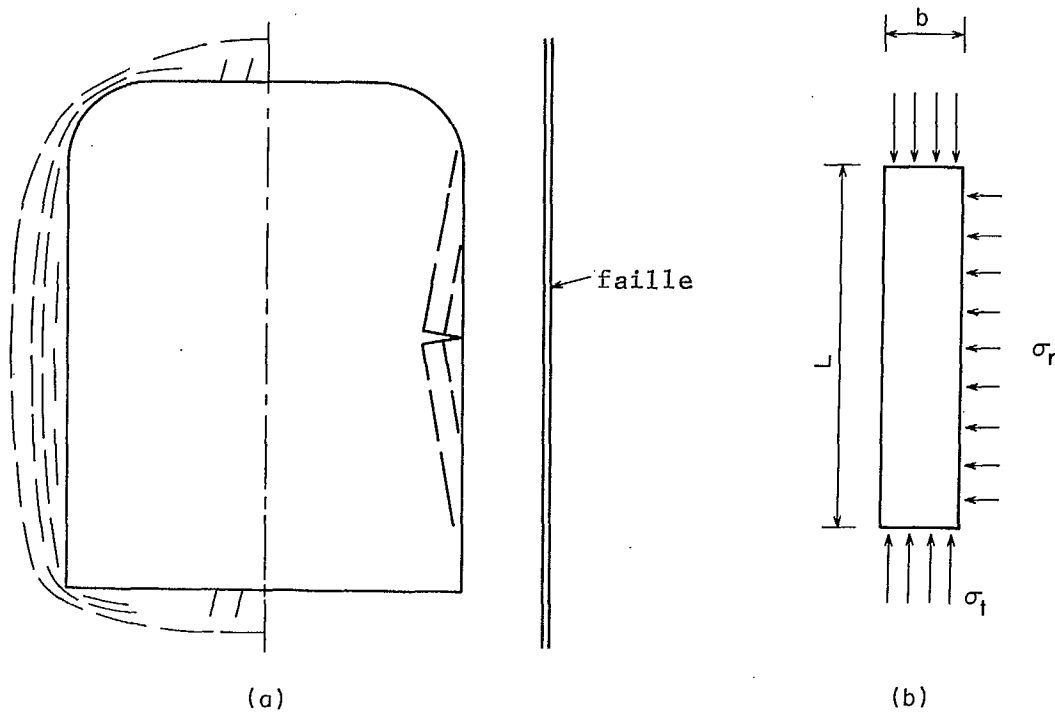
La rupture possible par flambage de la paroi d'une excavation.
